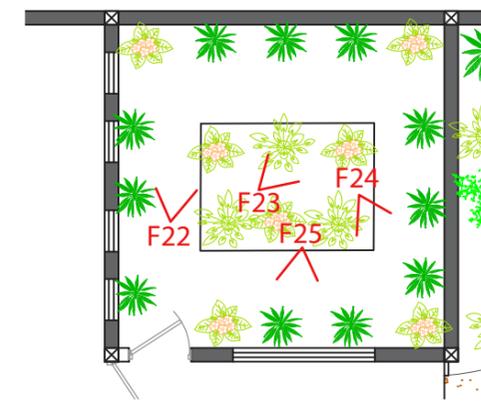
PLANTA DE VISTAS DEL VIVERO SECUNDARIO
